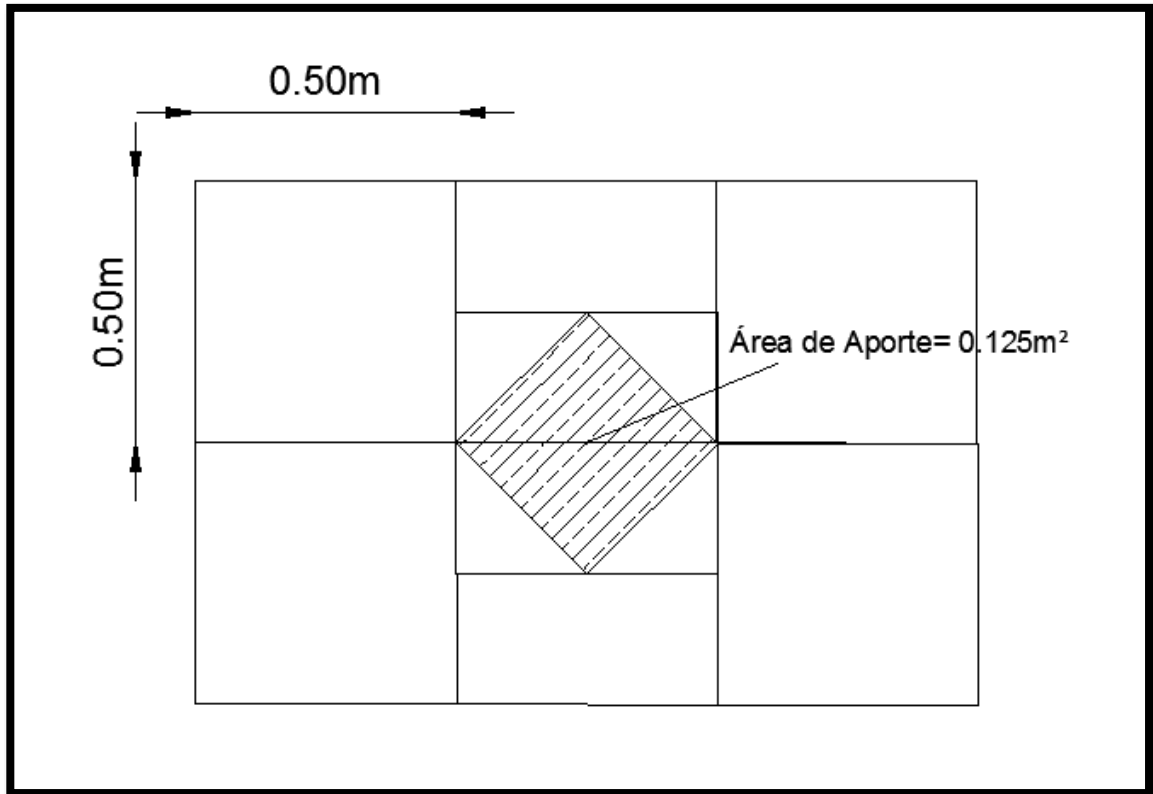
Vista en Planta Pirámide de base Cuadrada
